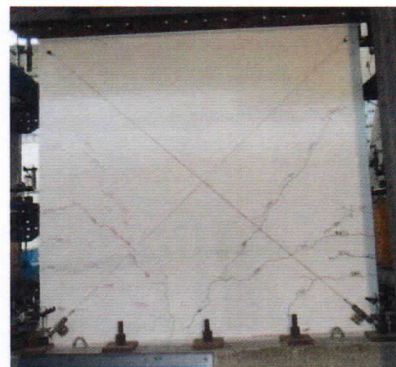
Primeras grietas diagonales en la cara norte para una distorsión 1/1500 Vista cara Norte.
